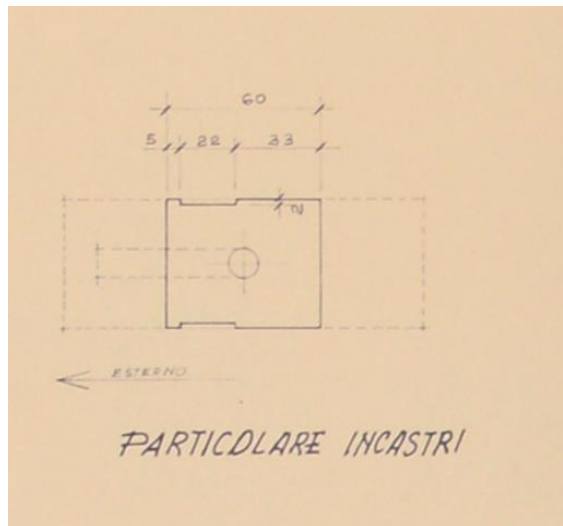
Particolare di A.1980.cap.us.T05 - Dettagli armature pilastri – Incastro pilastro/travi principali
